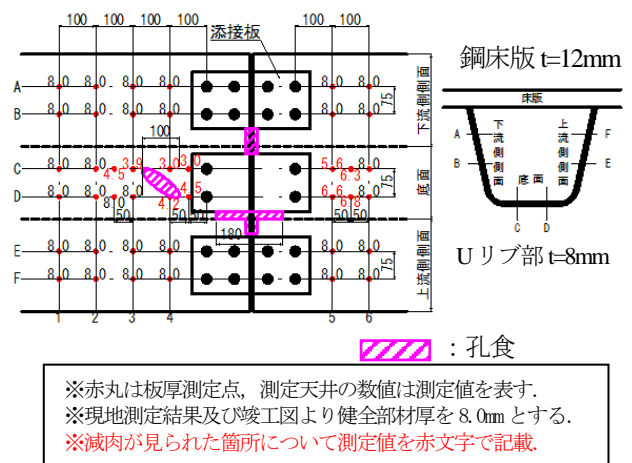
板厚測定箇所と結果 平面図(上)、断面図(下)
